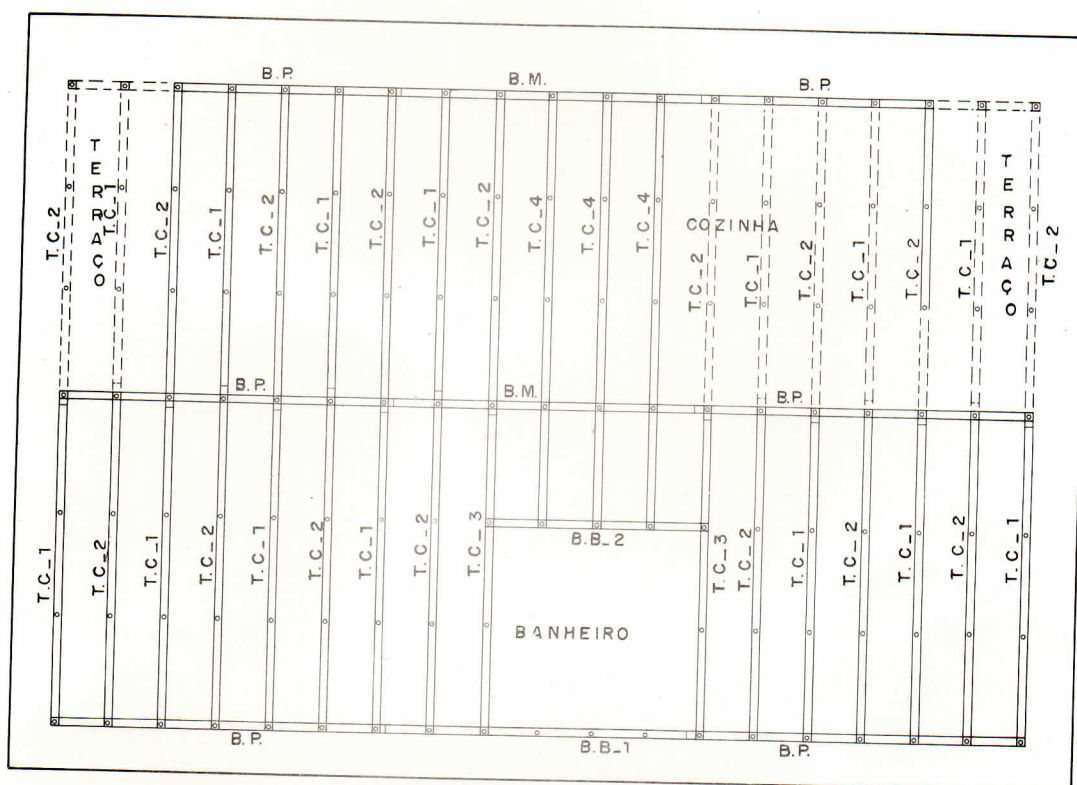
Planta baixa - baldrame e barrotes (base de madeira).
